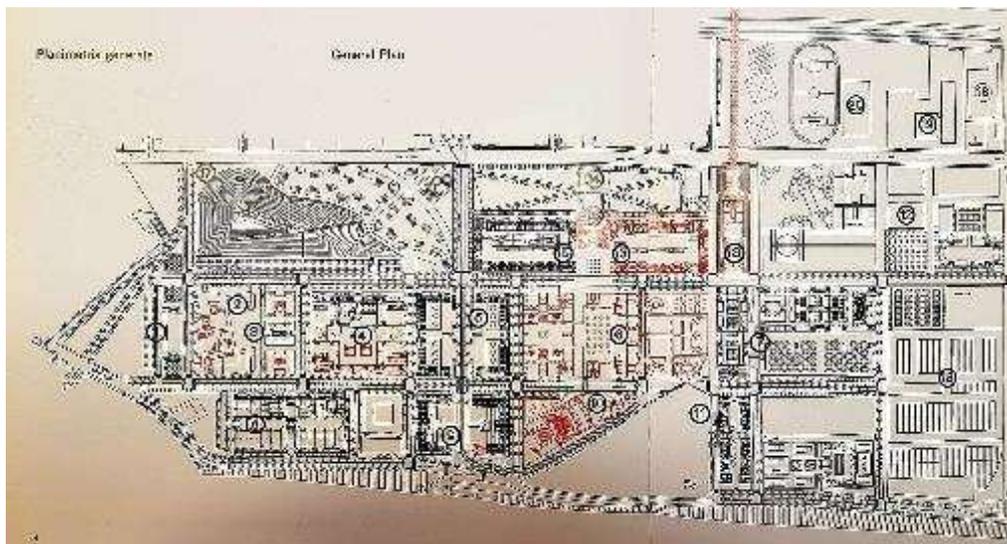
Planimetria generale del Progetto Bicocca , 1985
